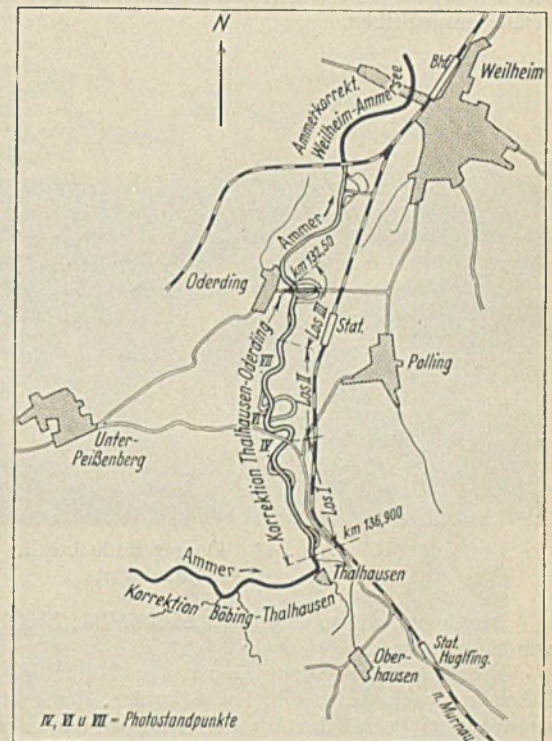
Ammerkorrektur Thalhausen—Oderding. Übersichts-Lageplan.
